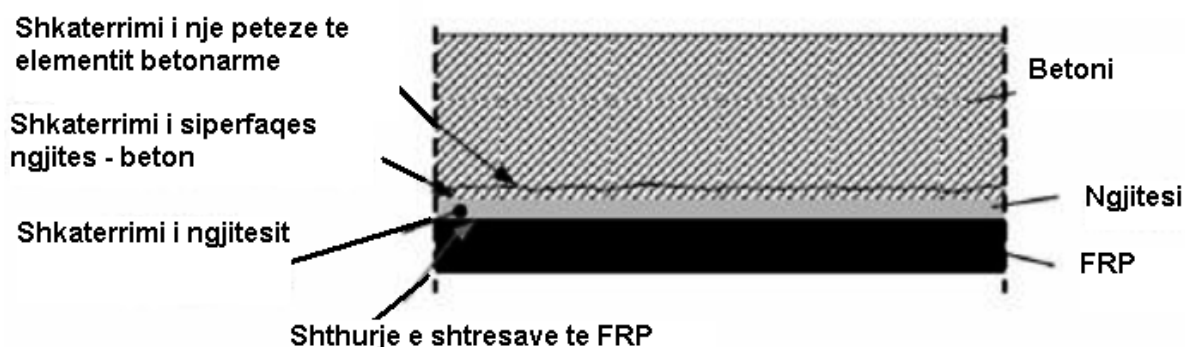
Mundësitë e shkatërrimit të lidhjes FRP – beton
